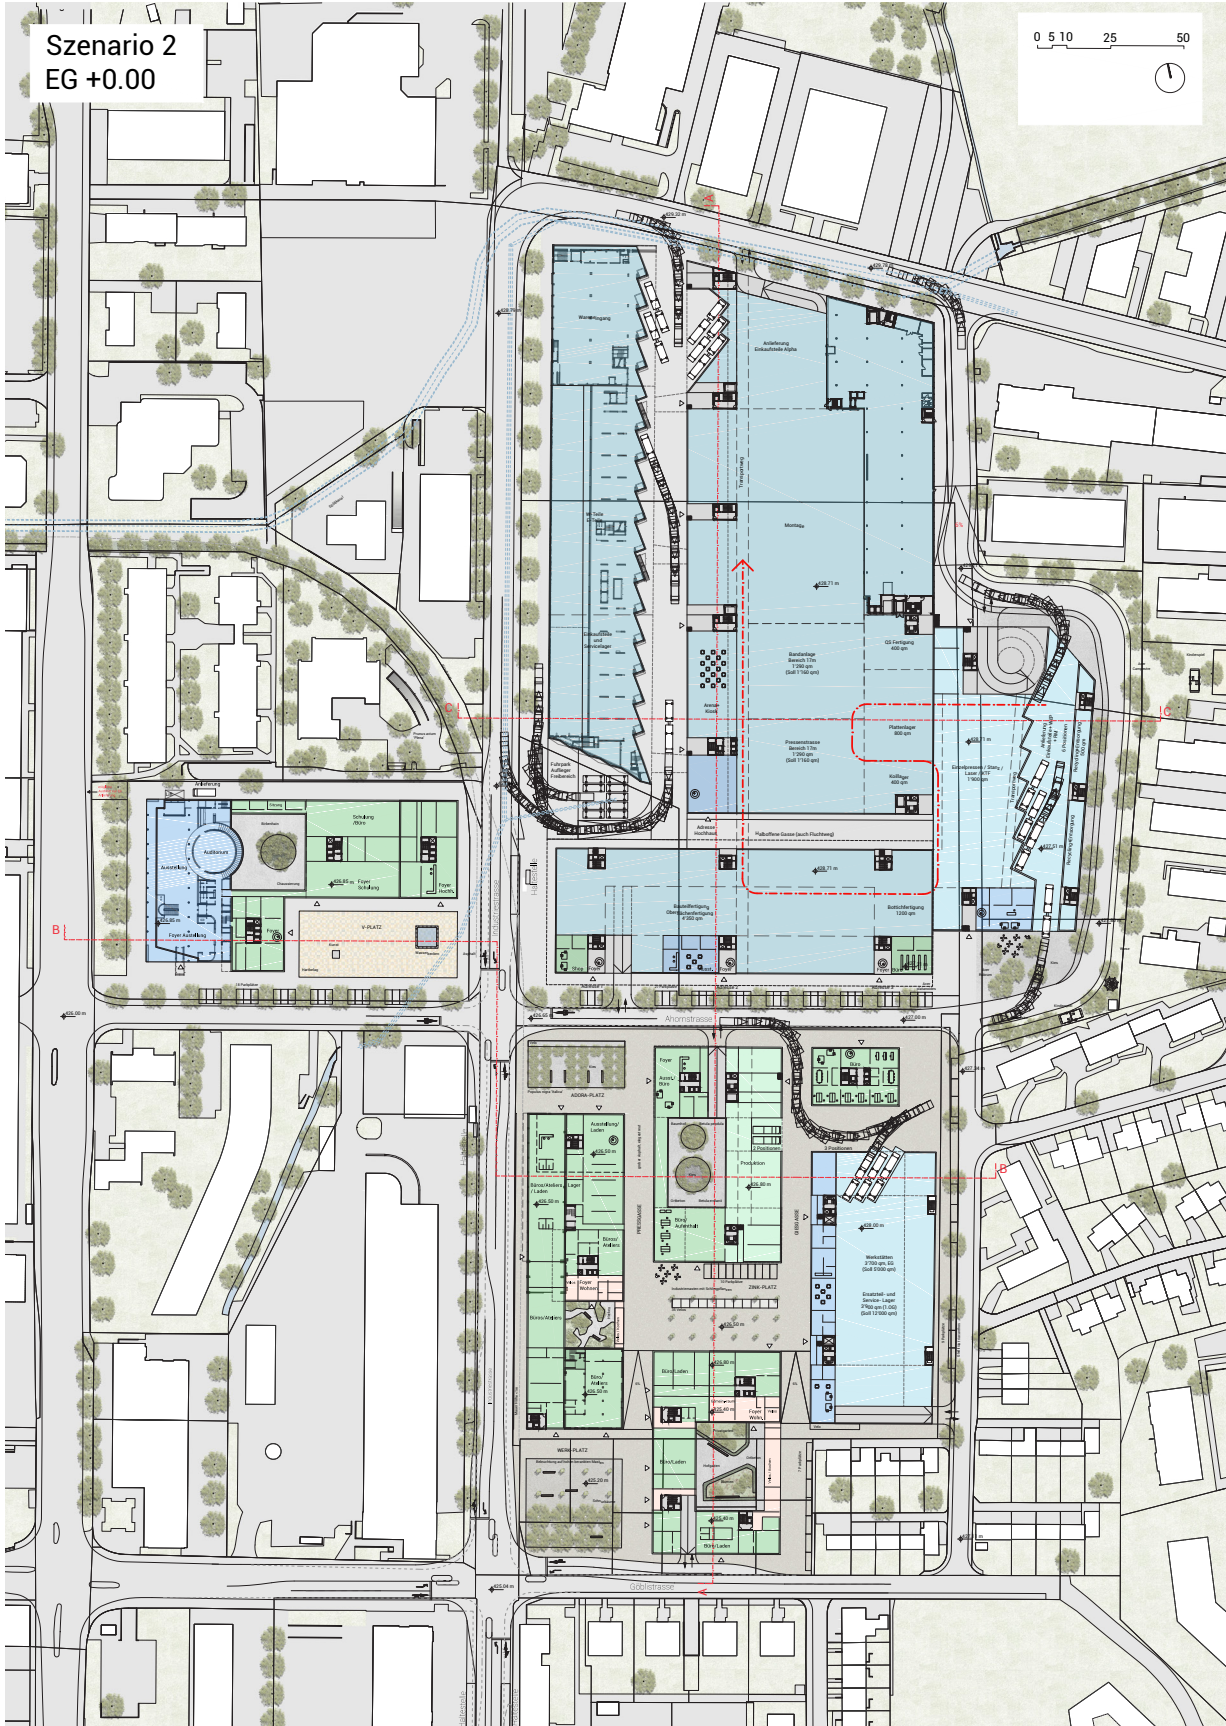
Grundriss EG Szenario 2
